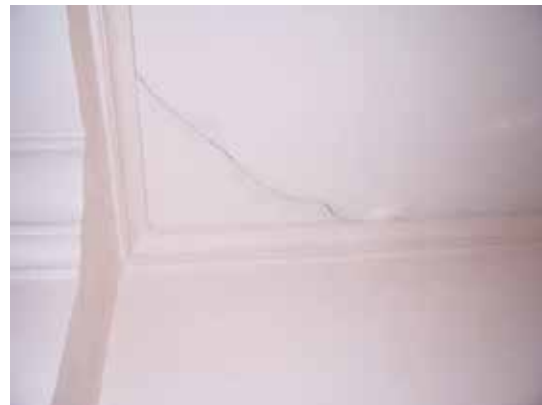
Grieta en el falso techo junto a la moldura.
